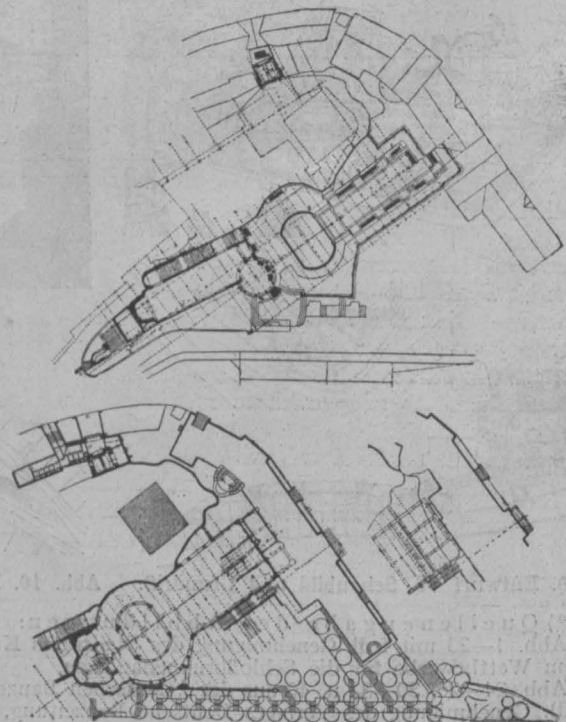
Entwurf IX. Grundrisse des Ausführungsentwurfes.
